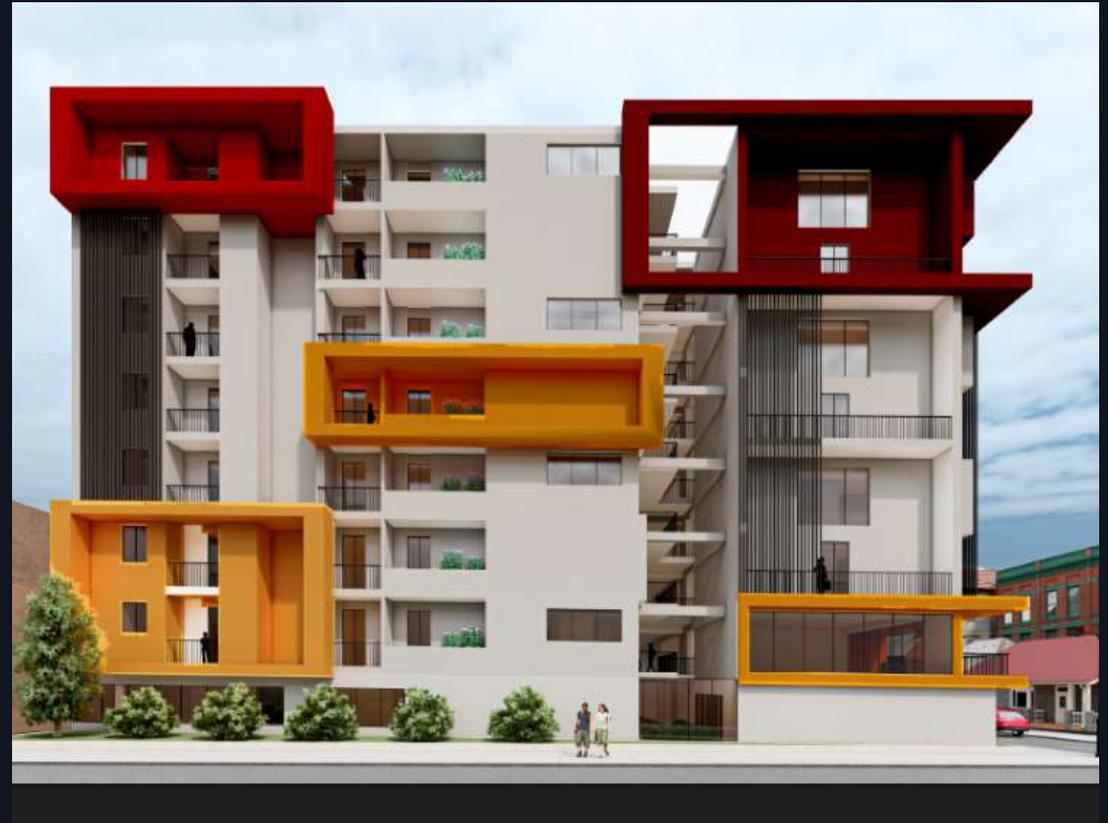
FUENTE: PROPIA. VISTA POR ALAMEDA DEL ALBA
